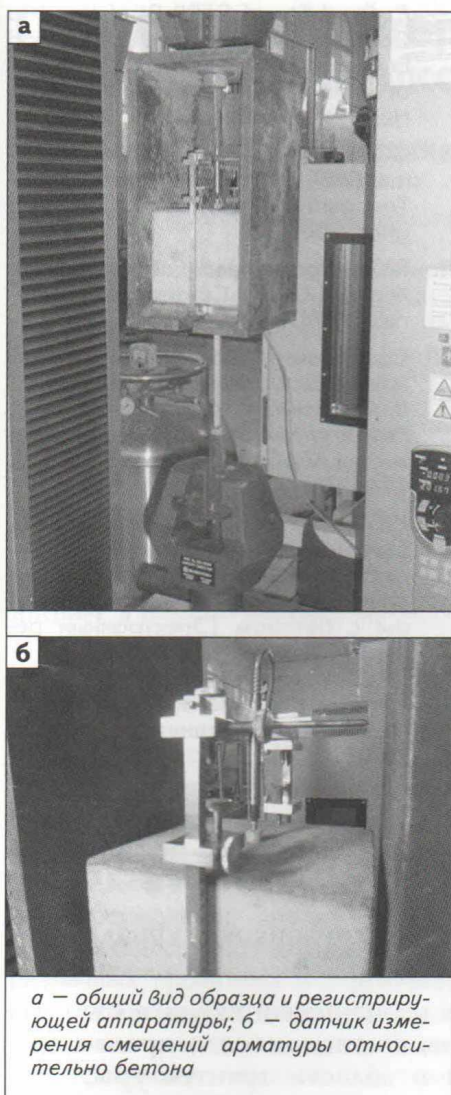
Испытание композиционной арматуры на сцепление с бетоном (pull-out test)
